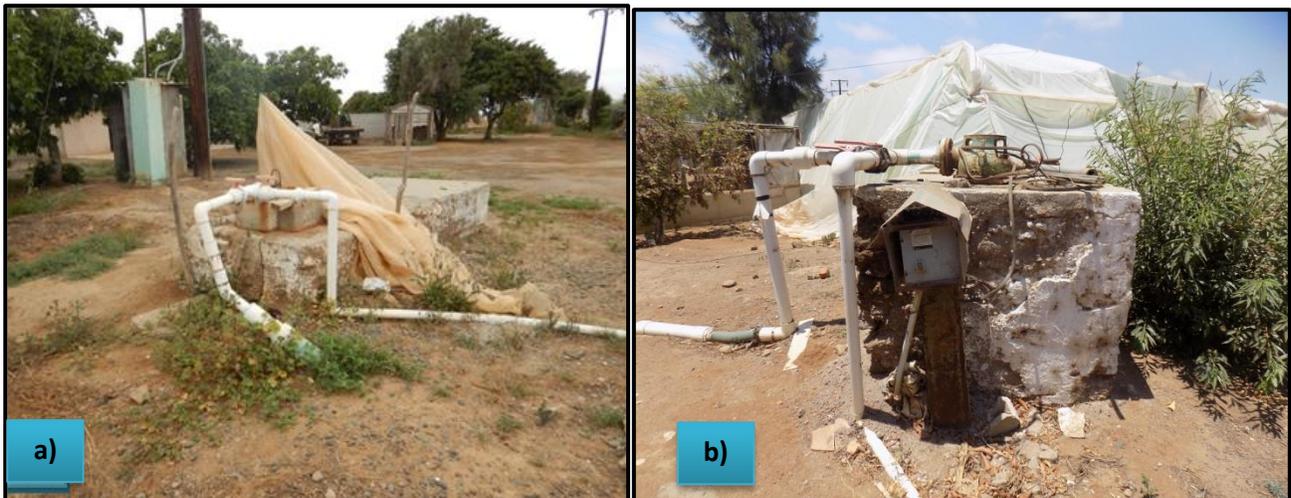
Vista de los pozos que abastecen la planta desaladora: a) pozo cinco ( ) y b) pozo seis ( ).
